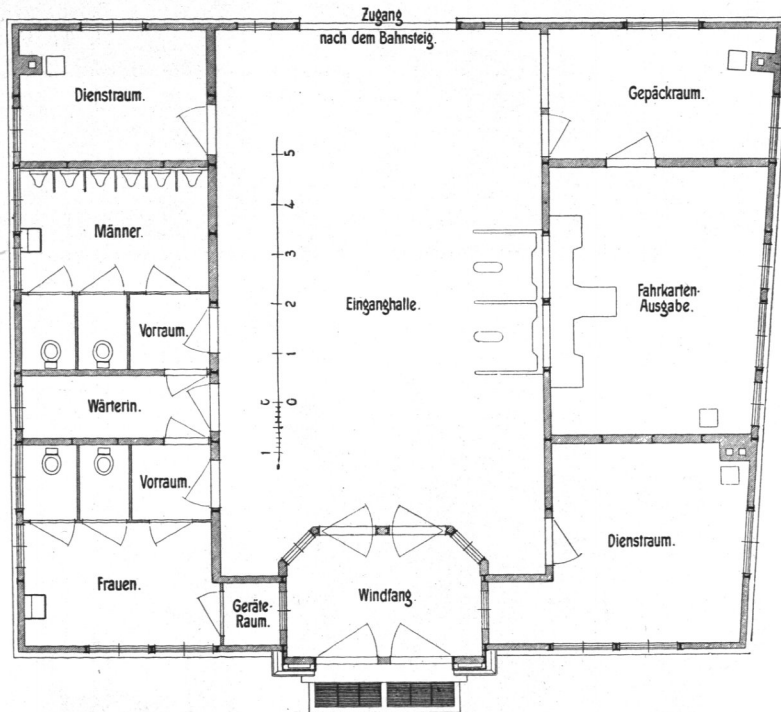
Haltestelle Wandsbecker Chaussee, Erdgeschoß.
